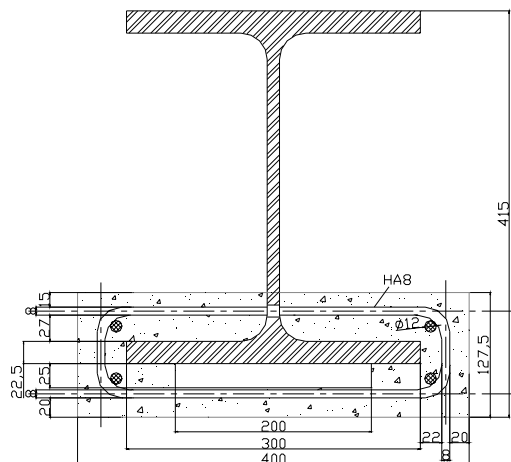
Coupe des poutres préfléchies testées au LCPC (dimensions en mm) / Cross section of the prebended beams tested at LCPC (in mm).
